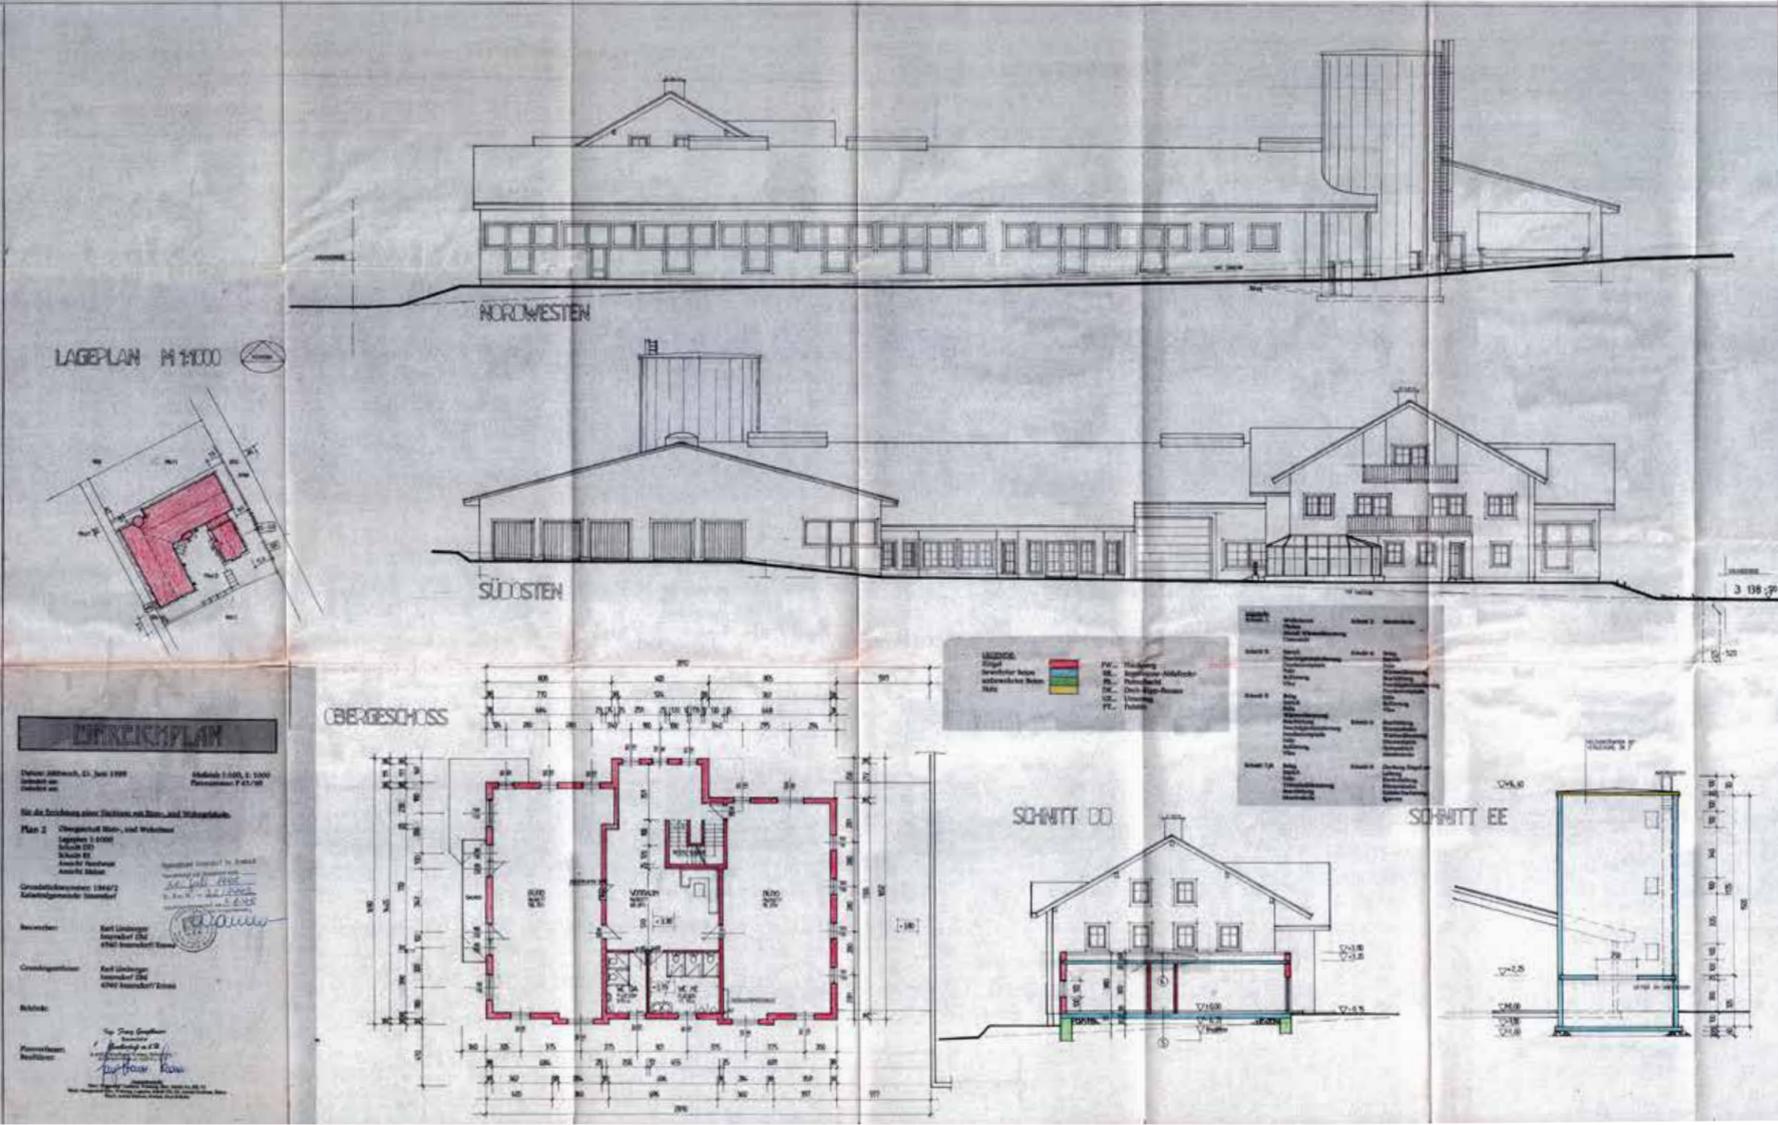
behördlicher Einreichplan 1995 - Lageplan, Ansicht Nordwest, Ansicht Südost, Grundriss Obergeschoß, Schnitt D-D, Schnitt E-E
